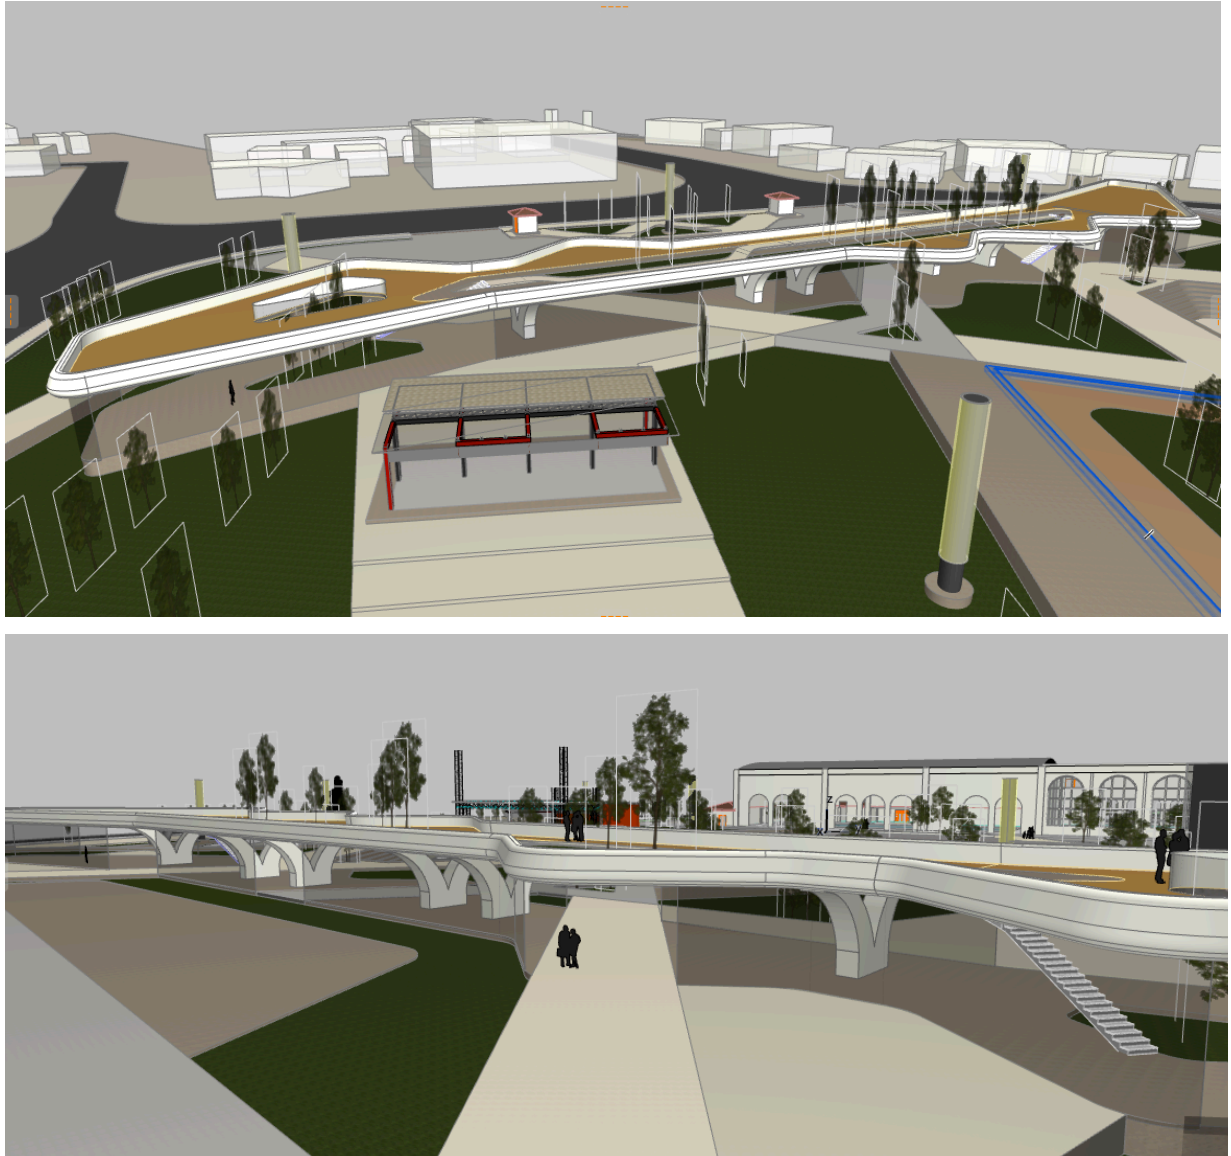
Hasil Akhir Perancangan Penampilan Bangunan Eksisting
